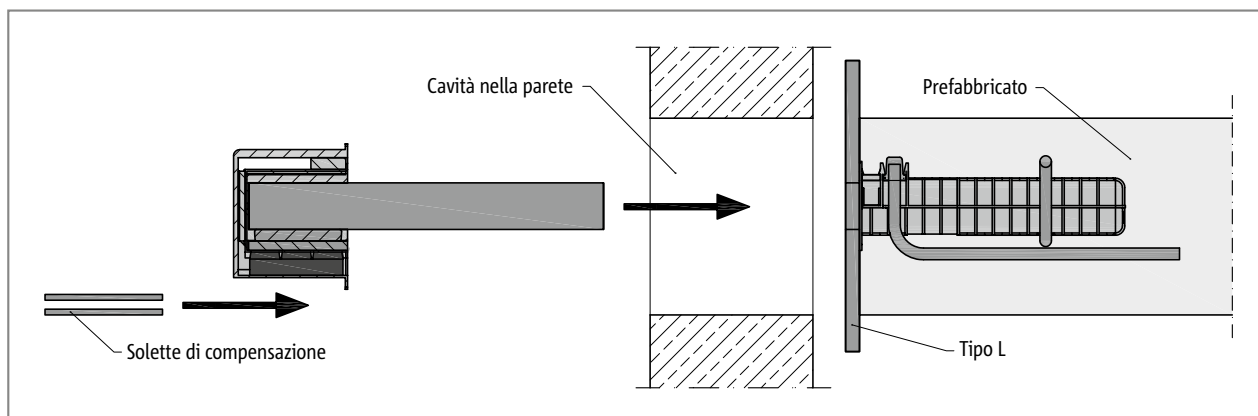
Schöck Tronsole® tipo Q: cavità nella parete (costruzione prefabbricata)
